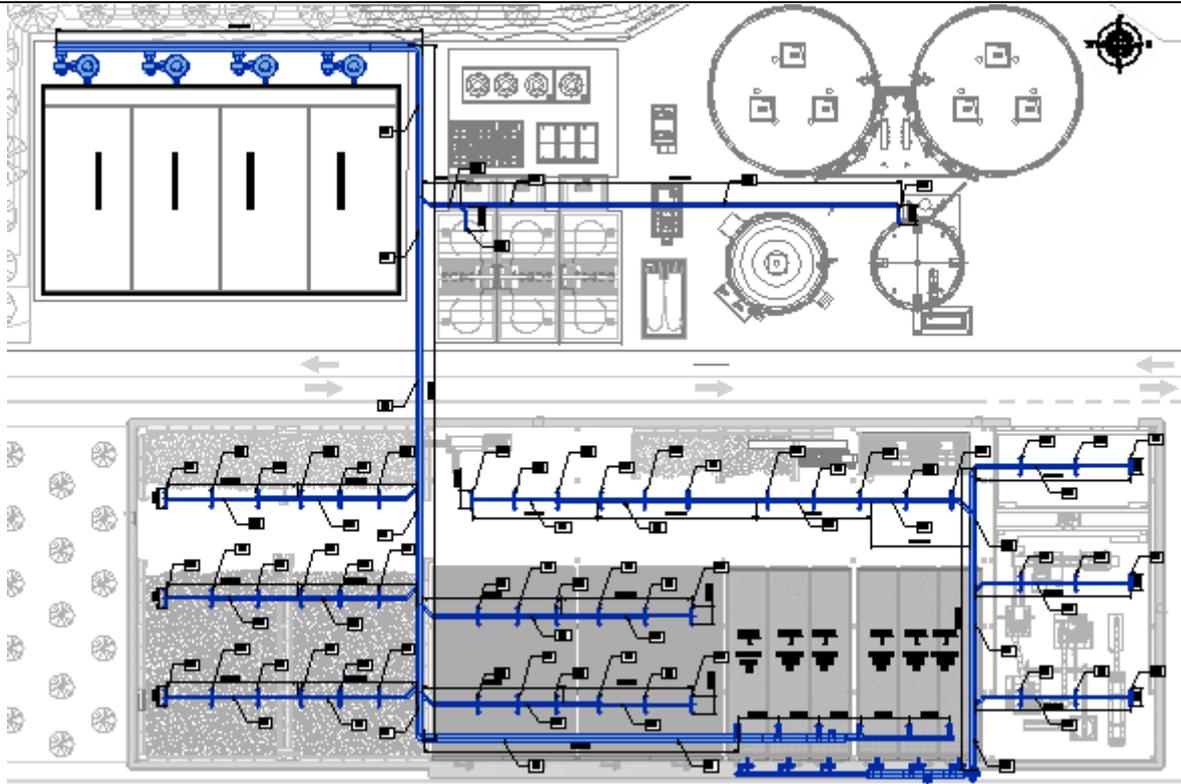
Planimetria rete aspirazione e ricircolo aria
